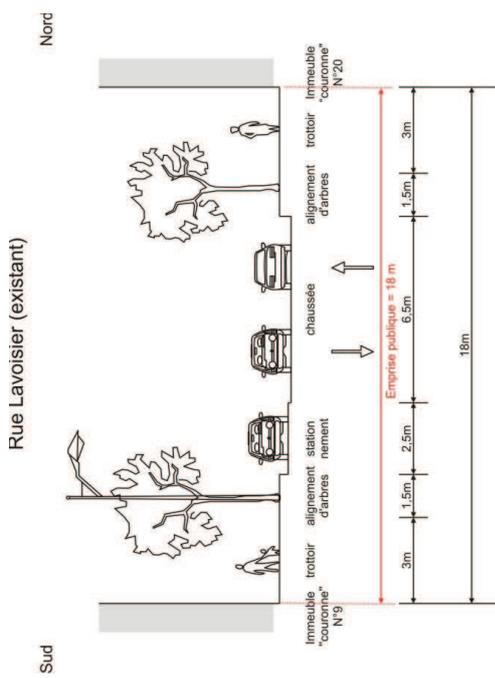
Situation existante (coupe 35) rue Lavoisier
